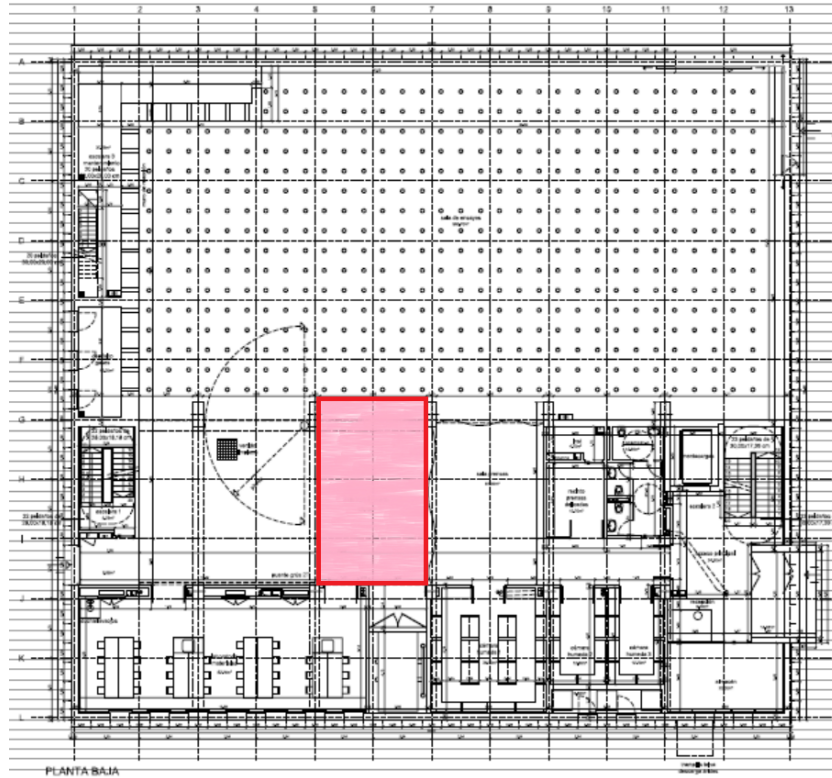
Localización de la prueba de carga en Planta Baja del ICITECH.
